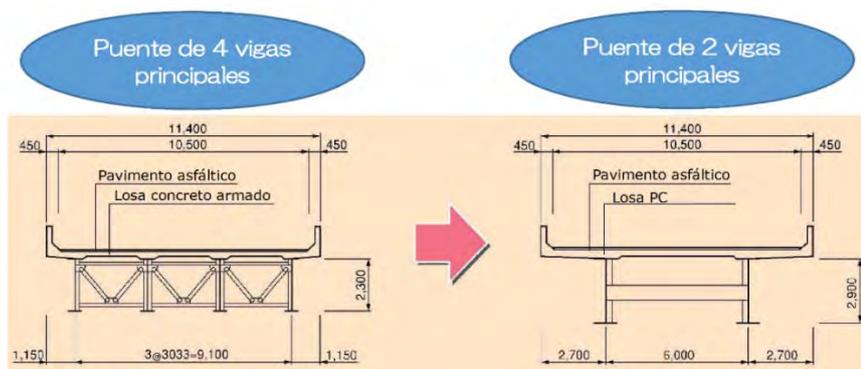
Estructuras con múltiples y con menor número de vigas principales de acero
